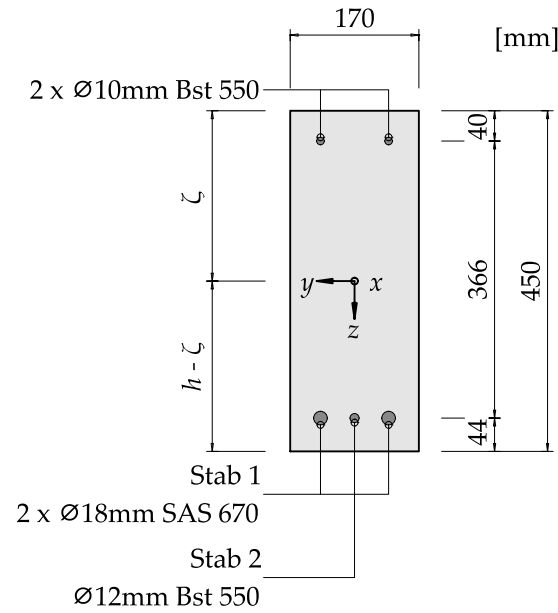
Querschnitt des Balkens dargestellt mit Zugbewehrung, ohne Schubbewehrung
